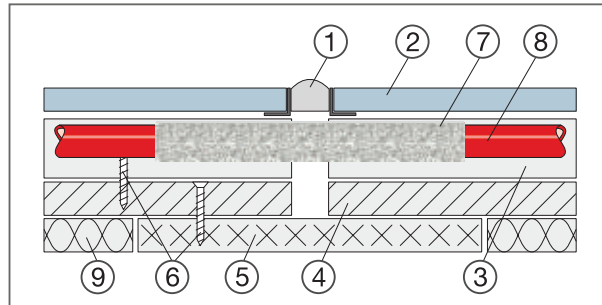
Schnitt Bodenaufbau auf Dämmung und Gipsfaser-Ausbauplatte
